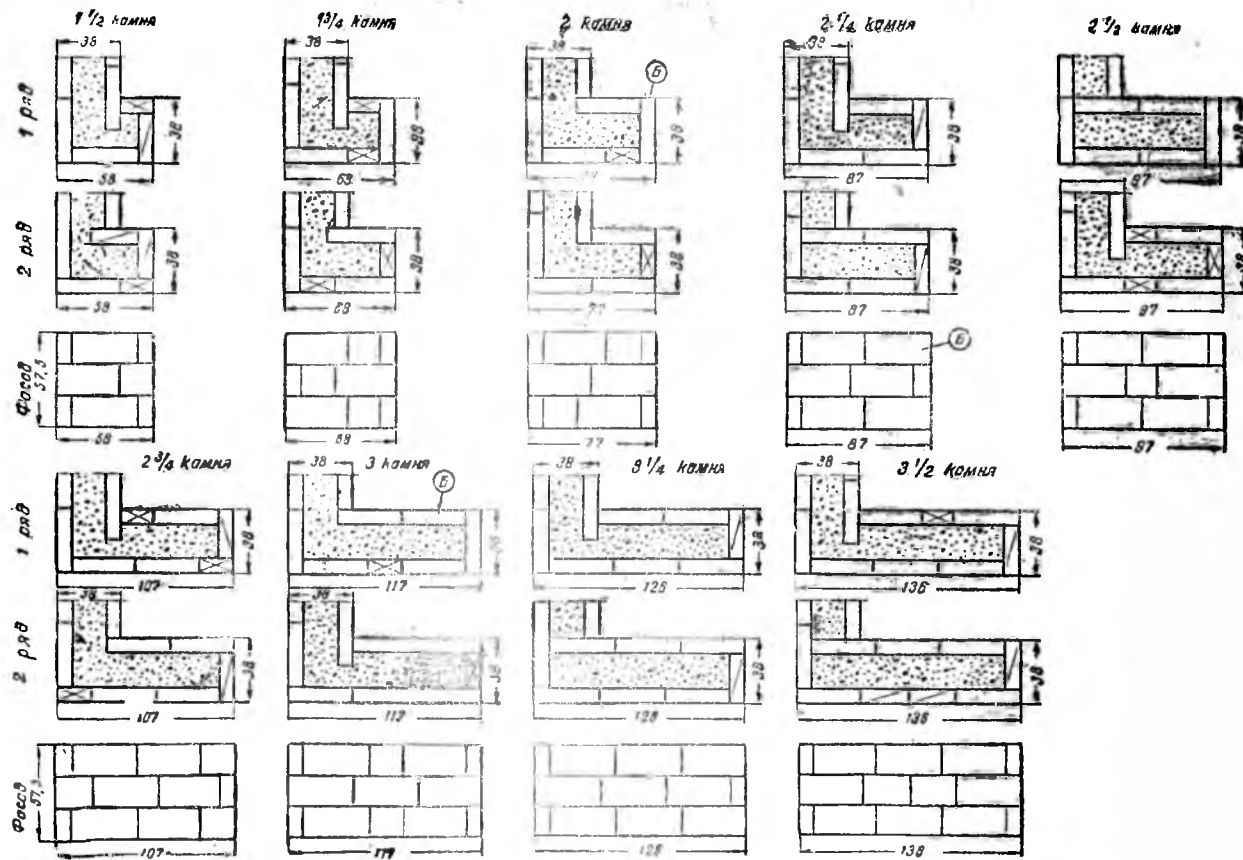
Засыпные стены из утоненных блоков. Кладка углов
